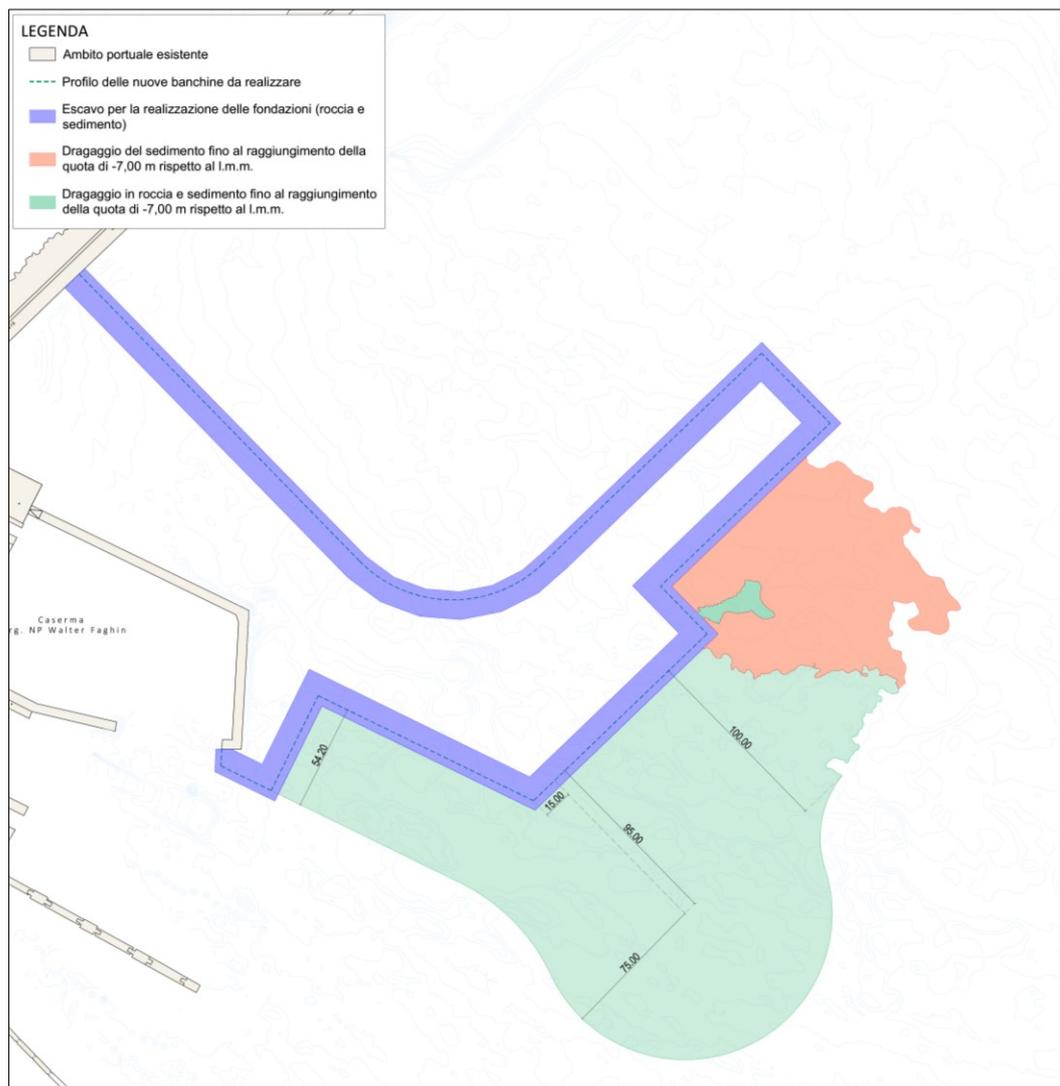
Planimetria del dragaggio (in blu è indicato l'escavo funzionale alla realizzazione delle fondazioni, in rosso il dragaggio del solo sedimento ed in verde il dragaggio in roccia)
